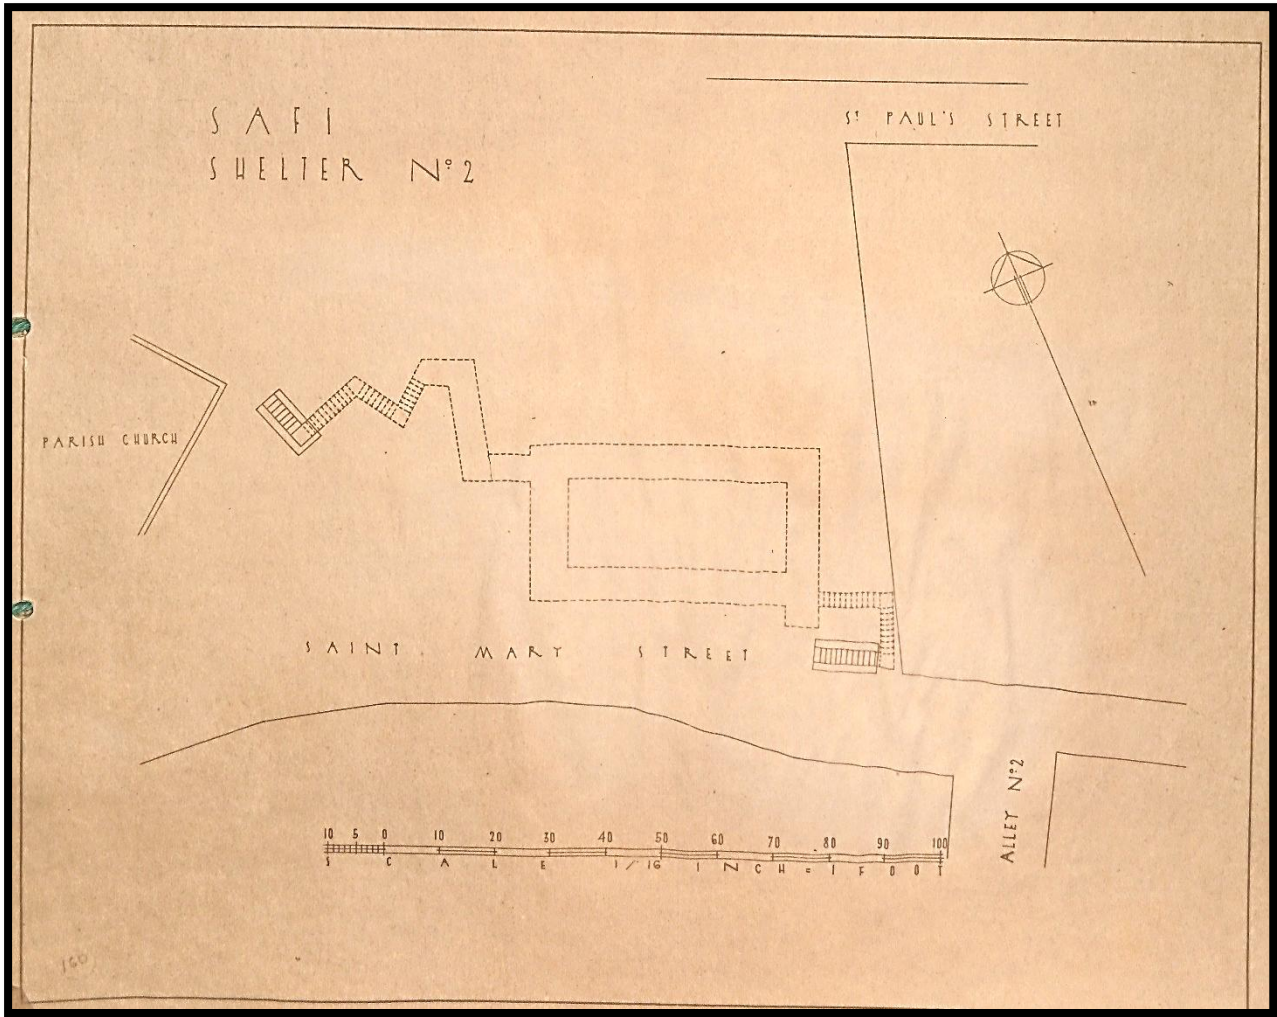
Planta do Abrigo nº2 "Saint Mary Street – St. Paul's Street – Alley nº2."
